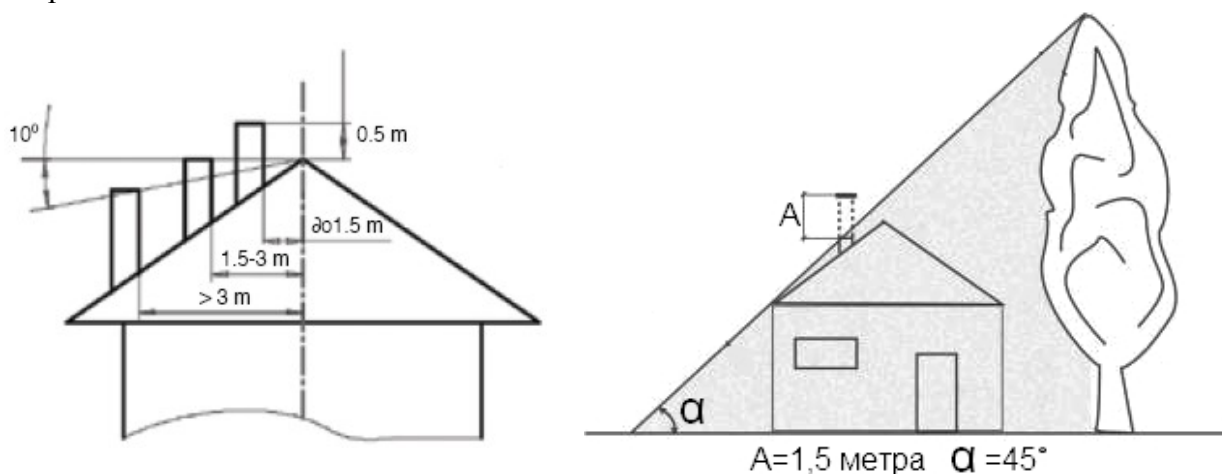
Рекомендуемая схема расположения дымохода относительно конька крыши
